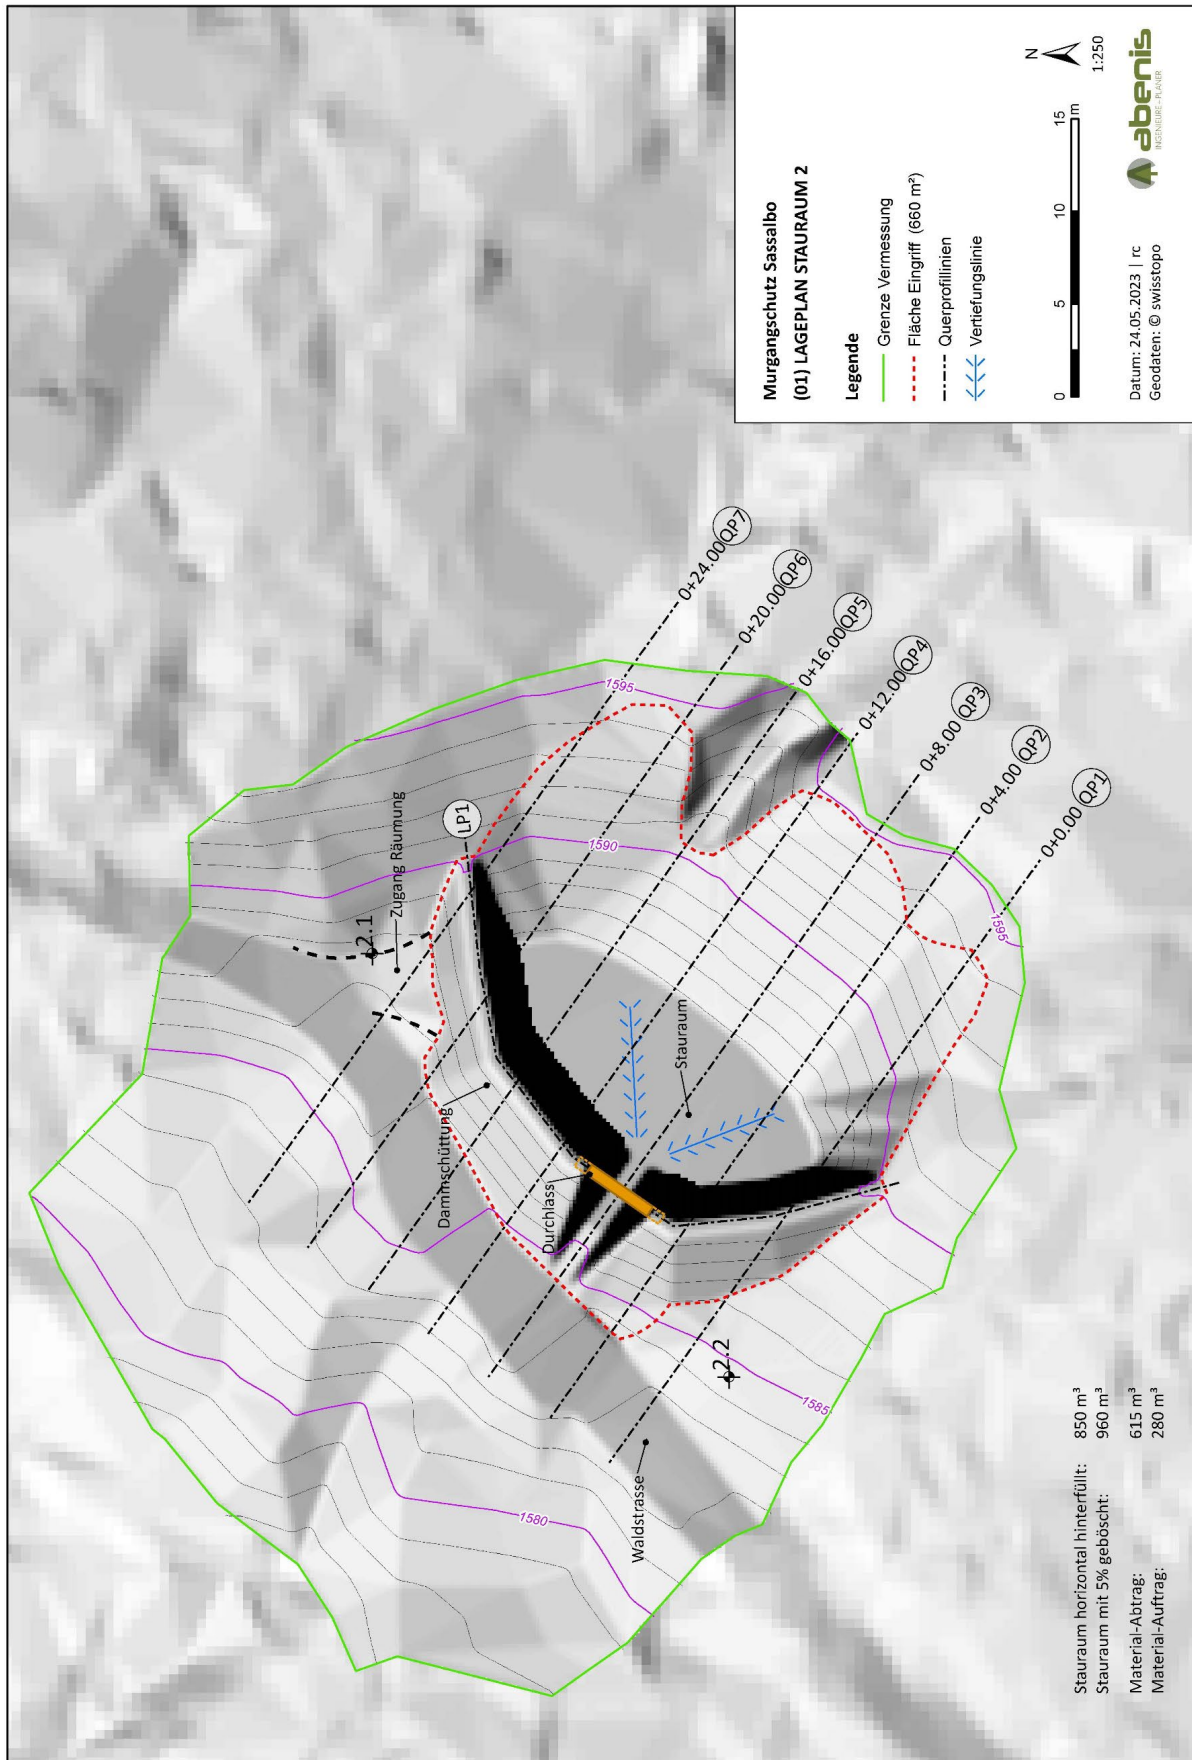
Lageplan Stauraum 2 an der Waldstrasse Paipidrin – Ross im Bosch d’Ain
